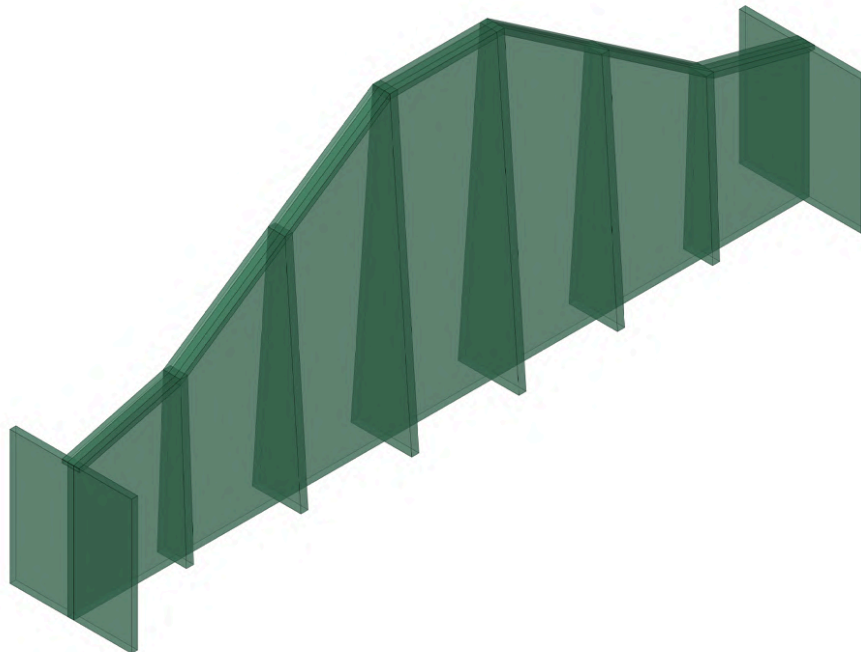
Axonometría del muro intermedio. Fuente: elaboración propia.
